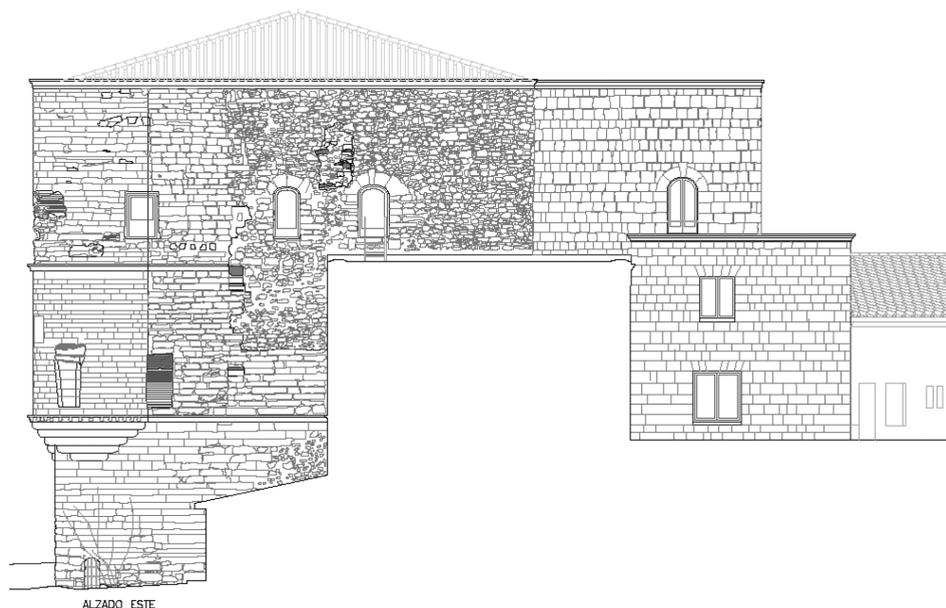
Alzado oriental de la torre del Caracol según levantamiento de la oficina de Francisco Jurado (2013). Se aprecia el encuentro entre la mampostería original de la torre y el volumen añadido incorporado en el proyecto de rehabilitación hotelera
